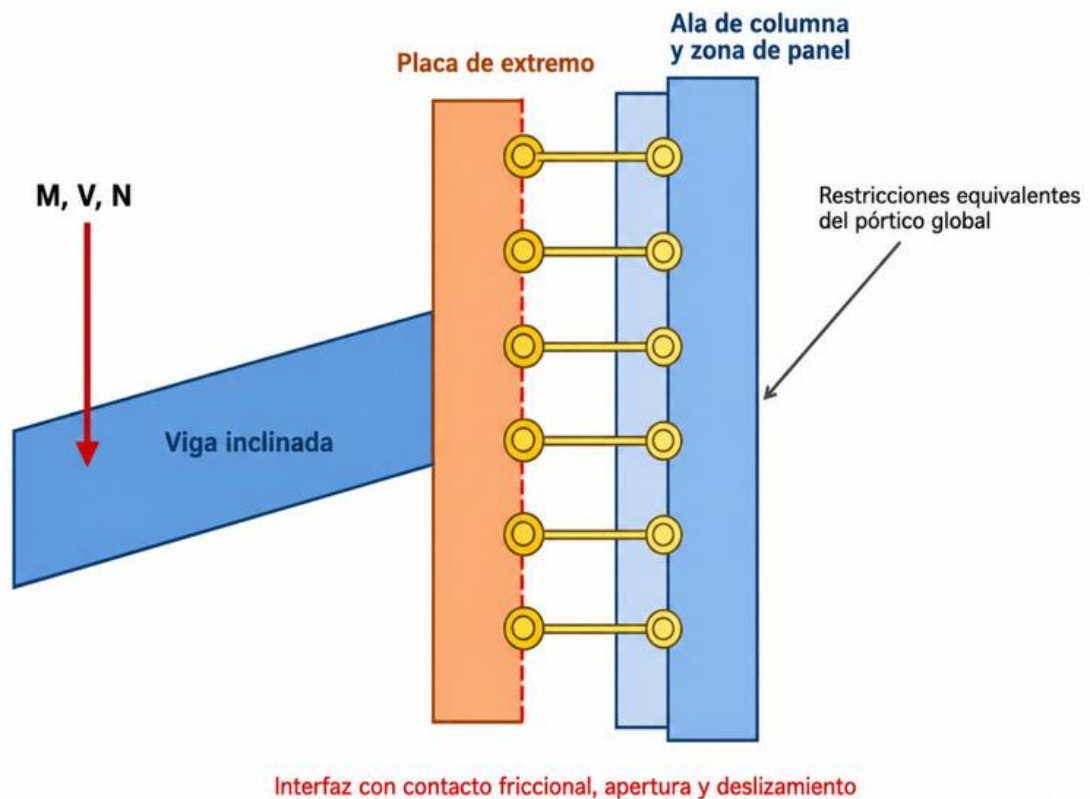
Modelado detallado de la conexión pernada viga-columna con placa de extremo.
